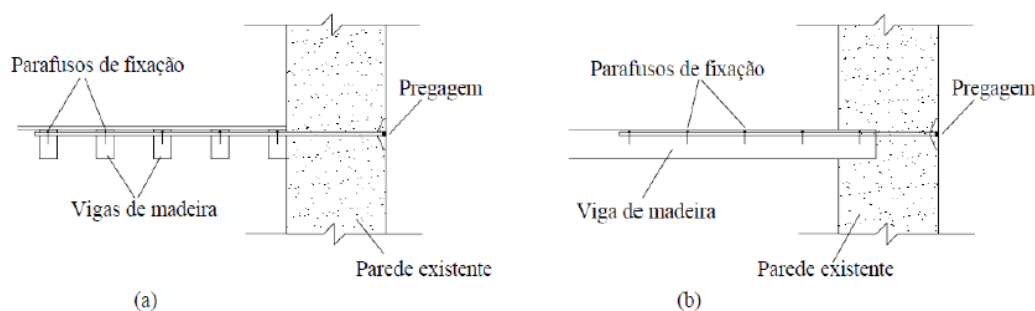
Pregagens entre paredes exteriores e os pavimentos: (a) vigas paralelas à parede; (b) vigas ortogonais à parede. [3]
